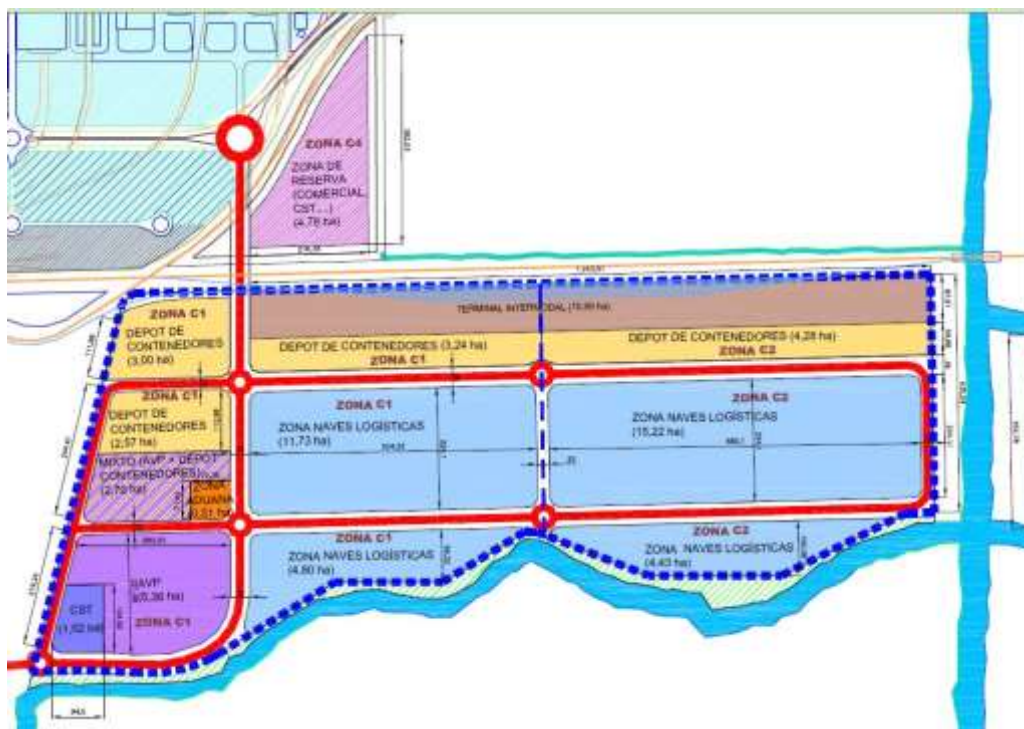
Planta general de la Terminal Extraportuaria de Logística propuesta
